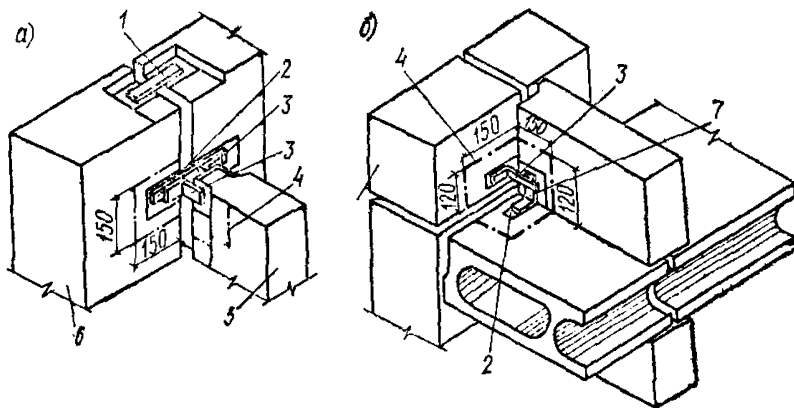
Узлы крепления панелей продольных стен к внутренним несущим стенам домов серии 1-468
